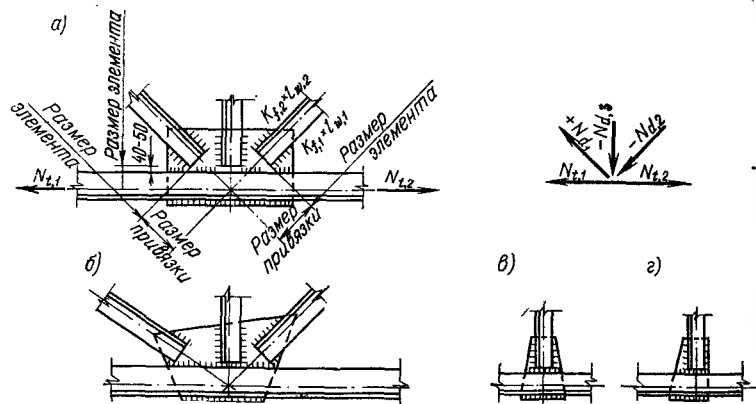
Прикрепление фасонки к поясам и раскосам фермы
